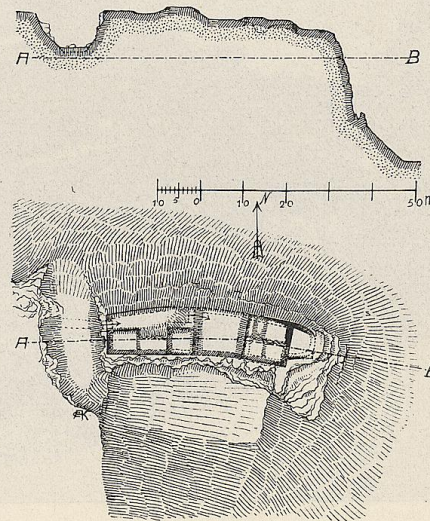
Burgstelle Hürgenstein Plan und Schnitt
